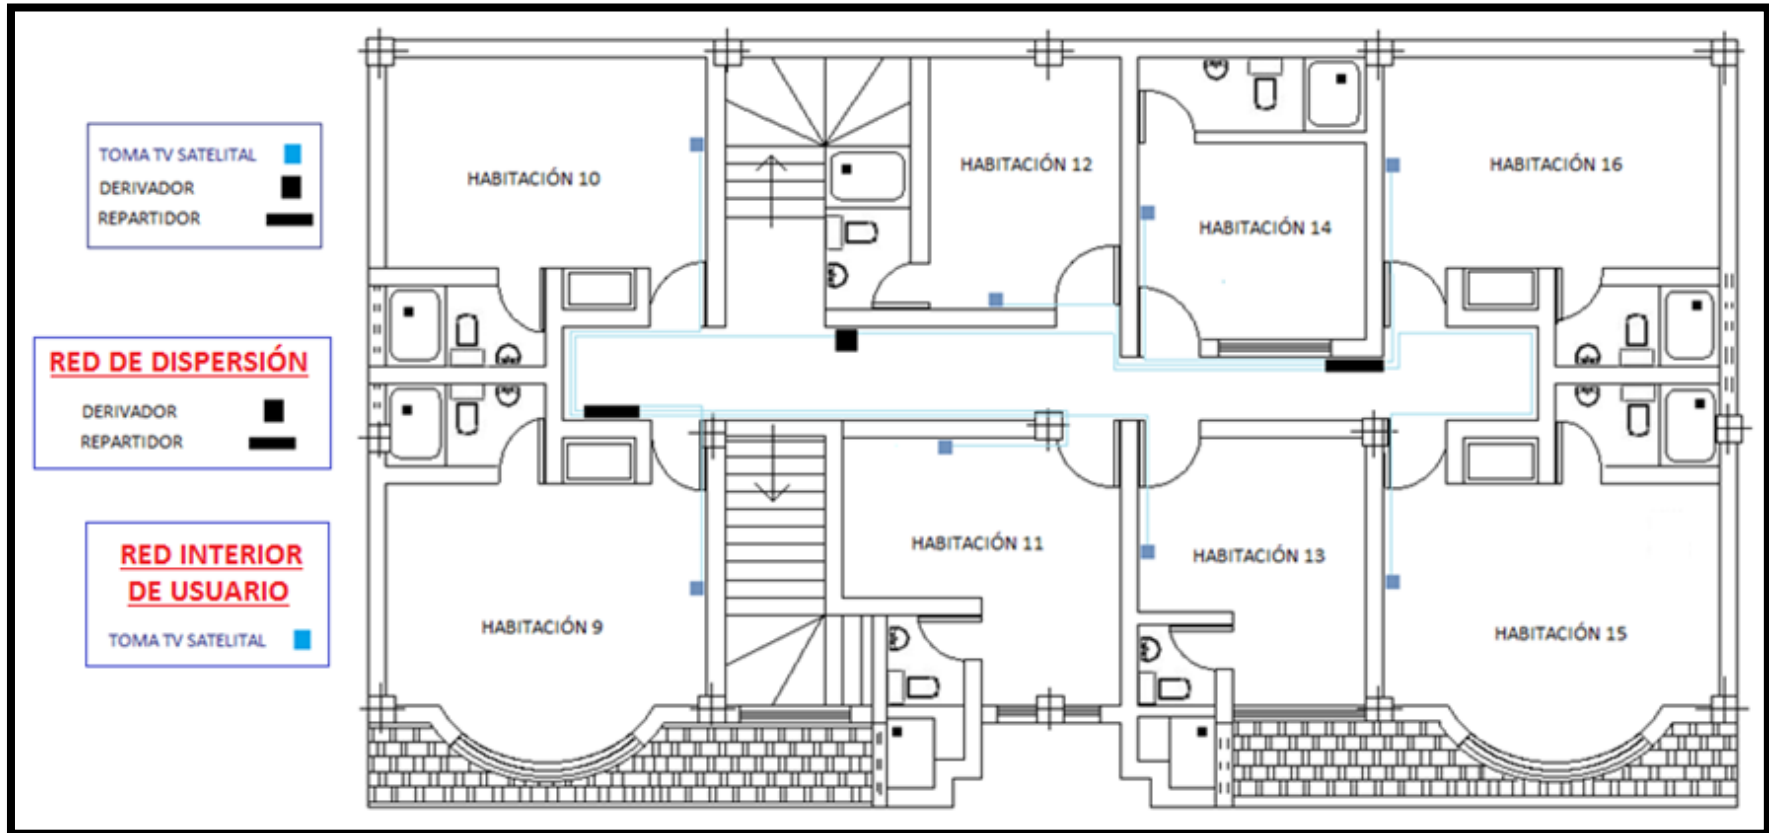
Puntos de TV satelital – Plano Segunda Planta
